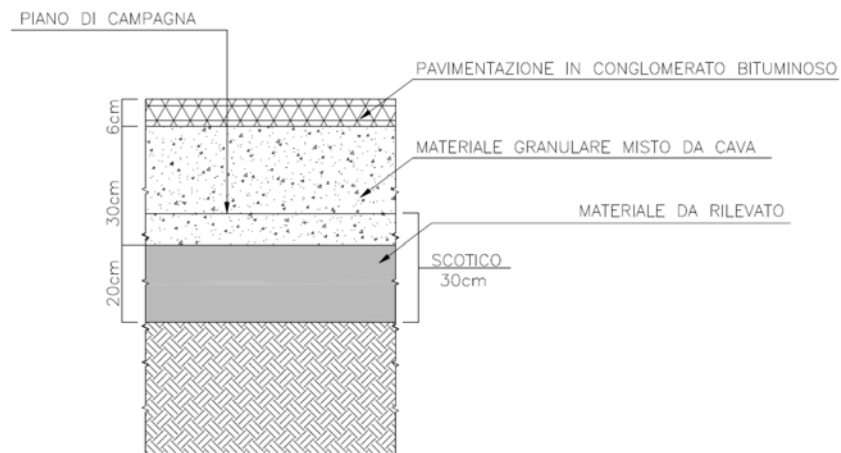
Pacchetto di pavimentazione nelle parti asfaltate
